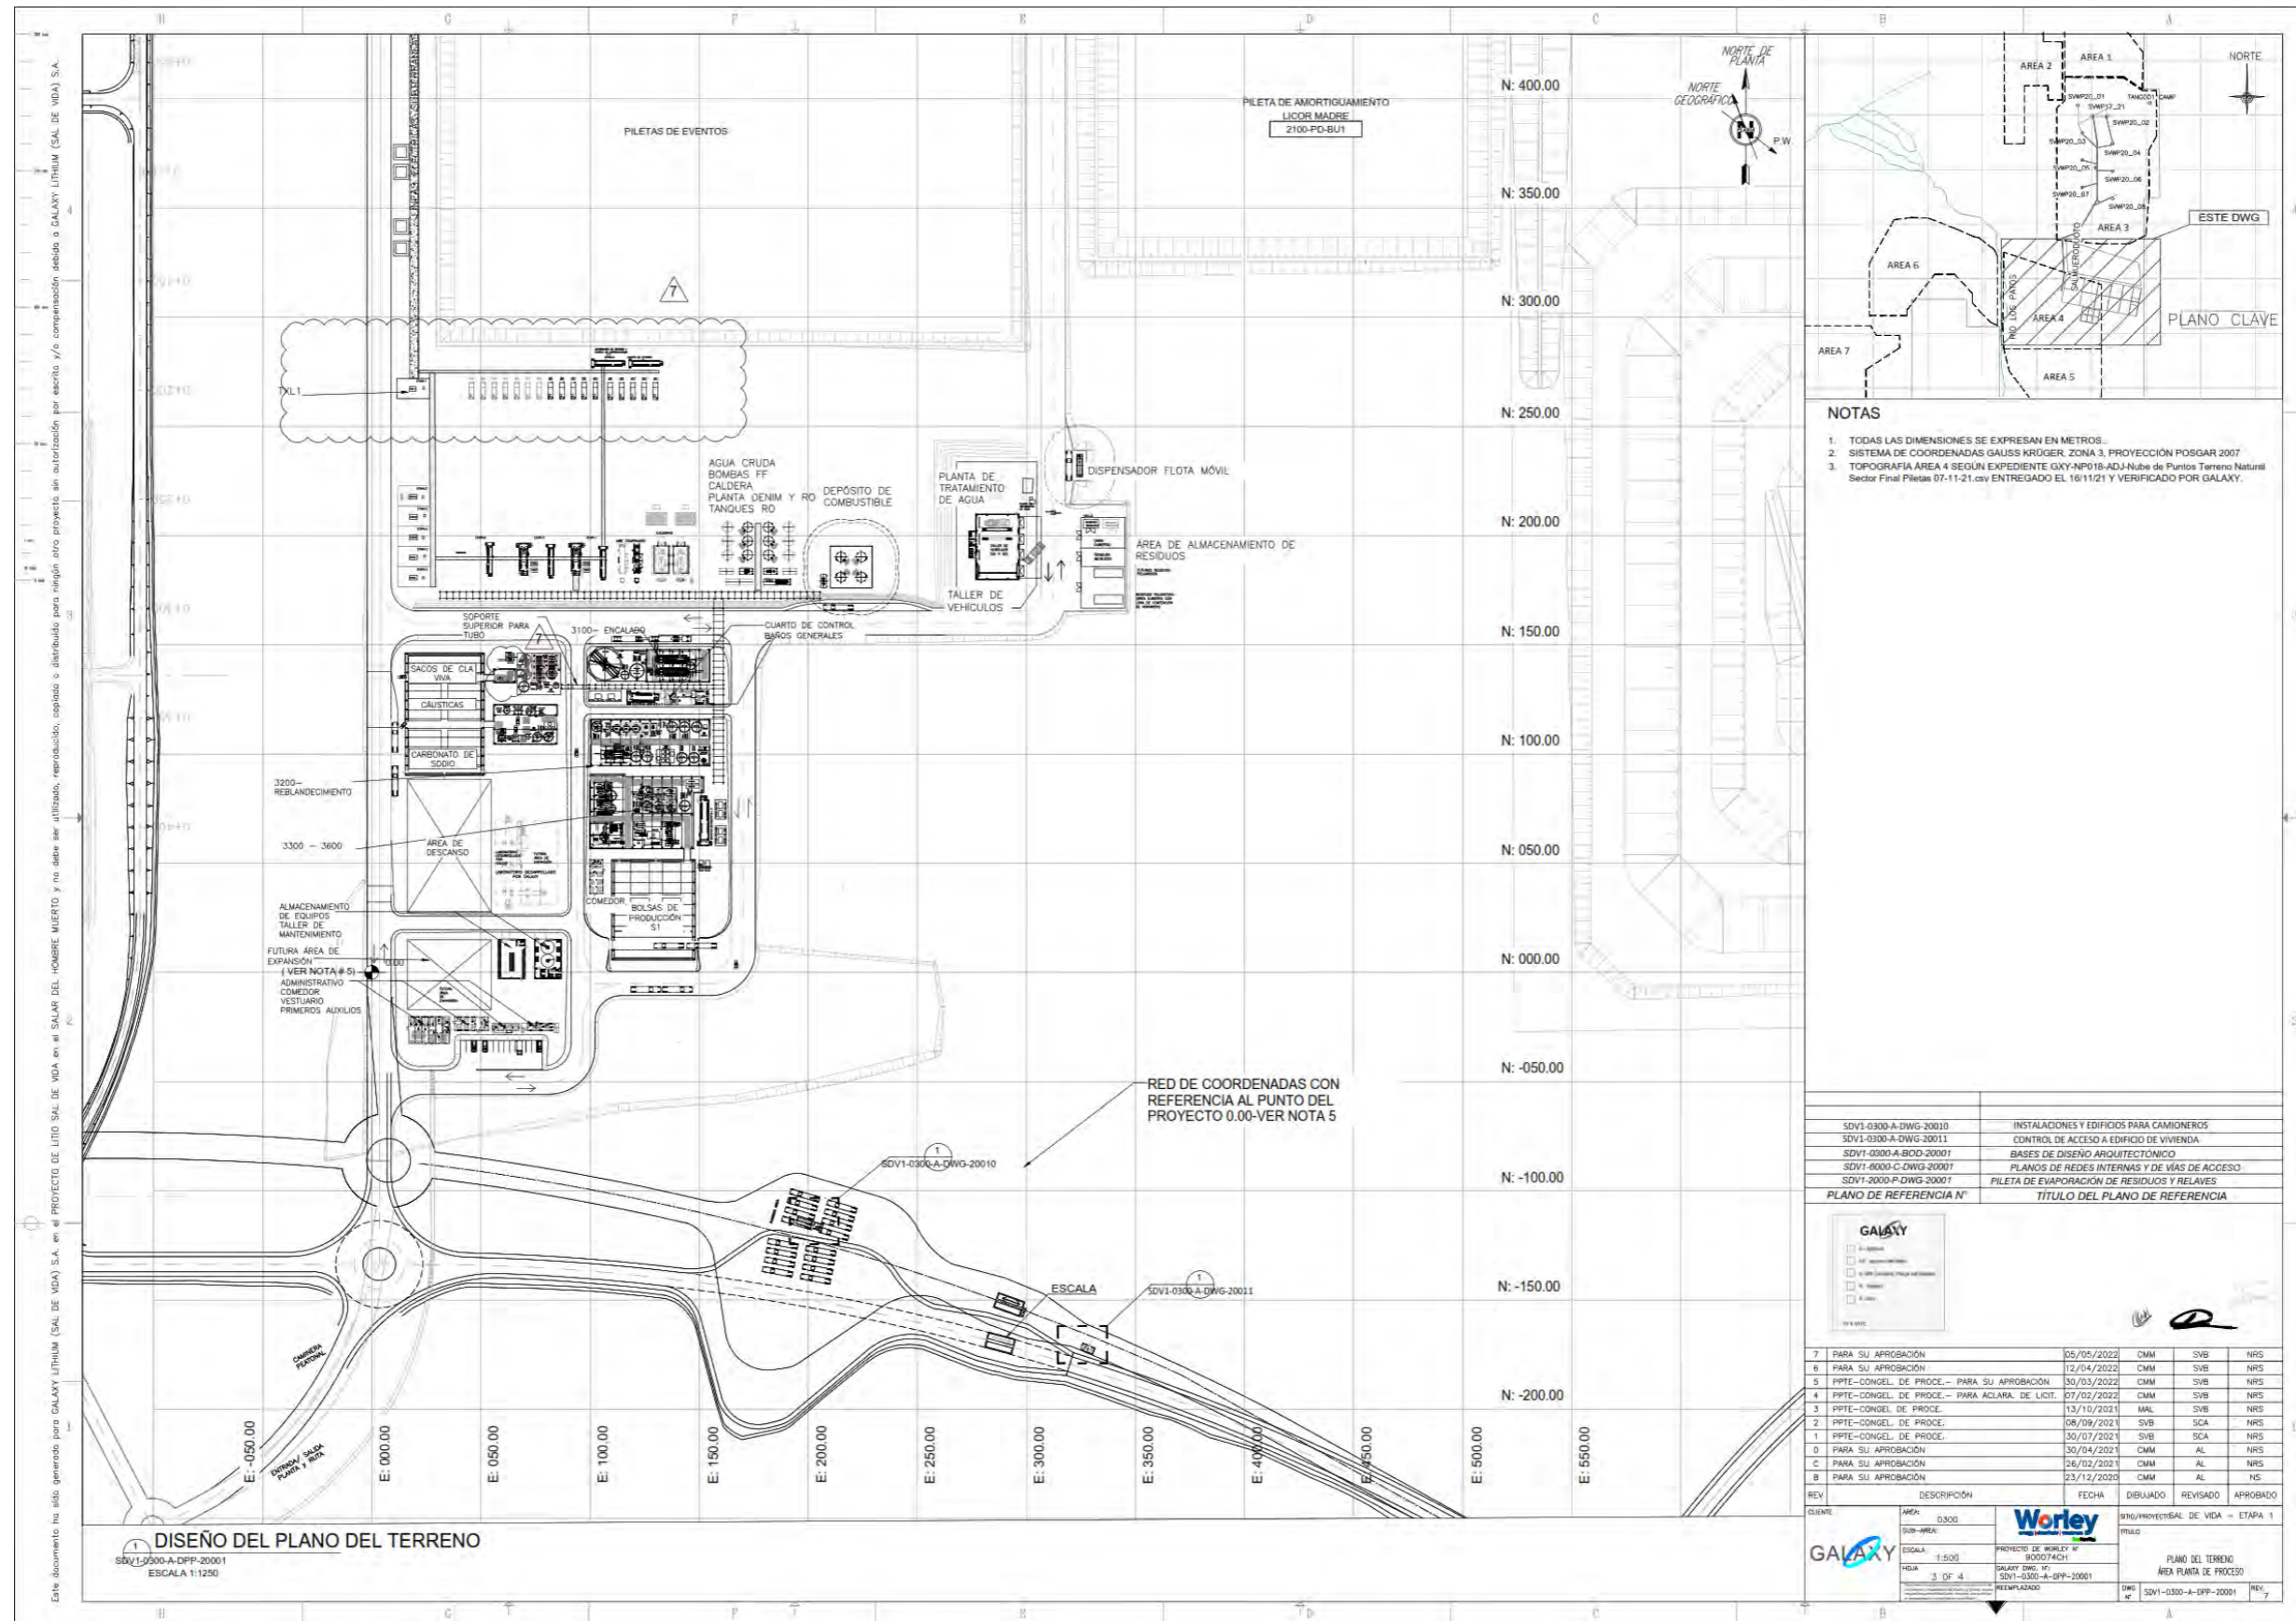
Plano con vista de la Pileta de eventos y Pileta buffer de licor madre, al norte de la Planta de procesos.
